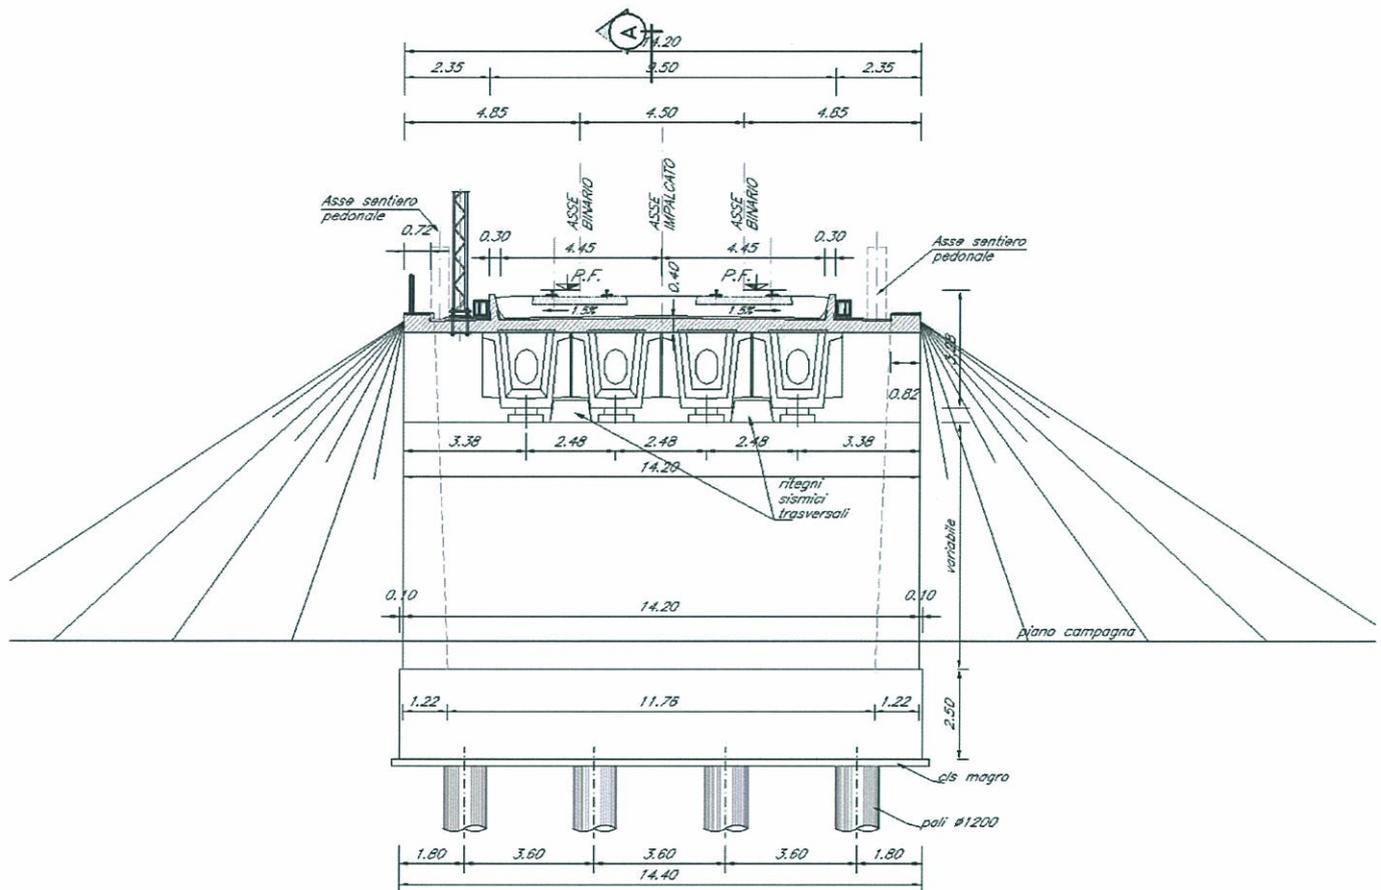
Sezione trasversale in asse appoggi della spalla tipo.
